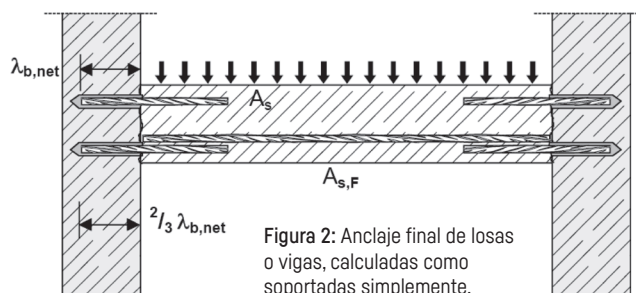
Anclaje final de losas o vigas, calculadas como soportadas simplemente.
